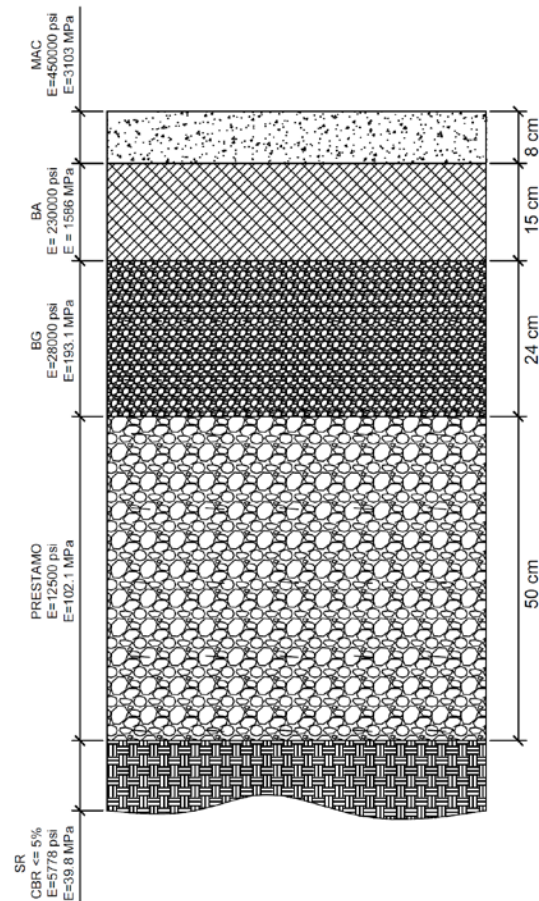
Estructura de pavimento diseñada proyecto Chilamate - Vuelta de Kooper.
